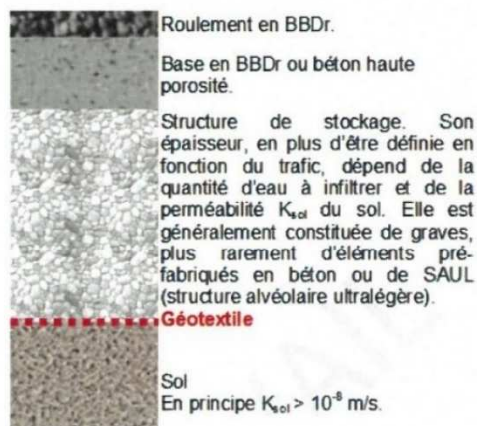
Exemple de structure de chaussée infiltrante avec couche de roulement en béton bitumineux drainant (BBDr)
